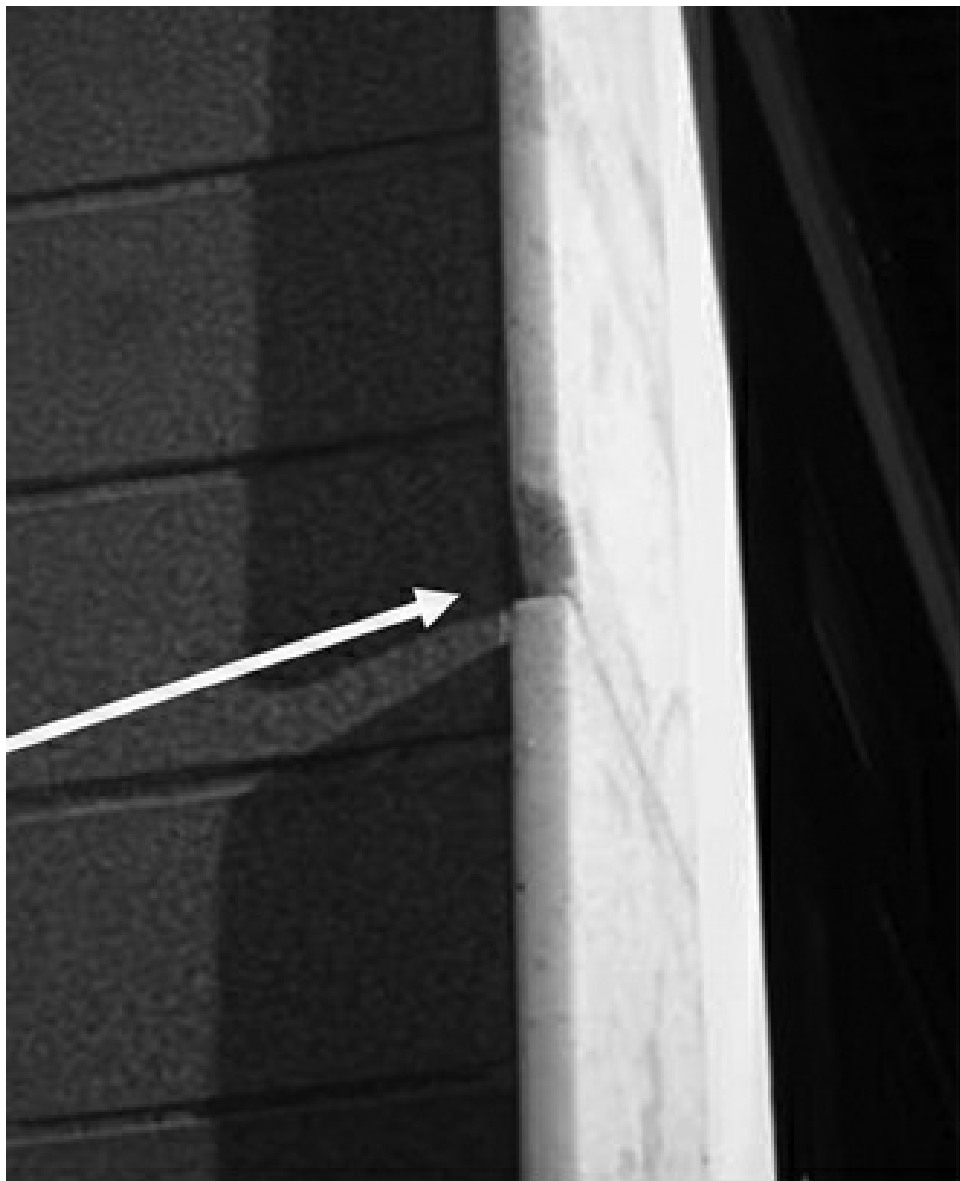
Fachada principal com pedras mármore quebradas.
